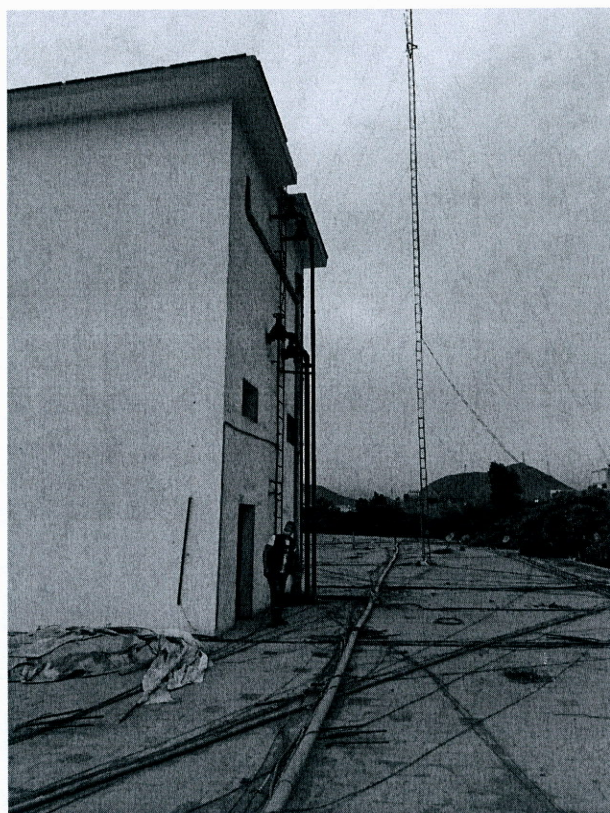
Azotea: Se observa la corrosión de las válvulas de sectorización y tubería de PVC no cuenta con soportería y no tiene un orden de instalación.
